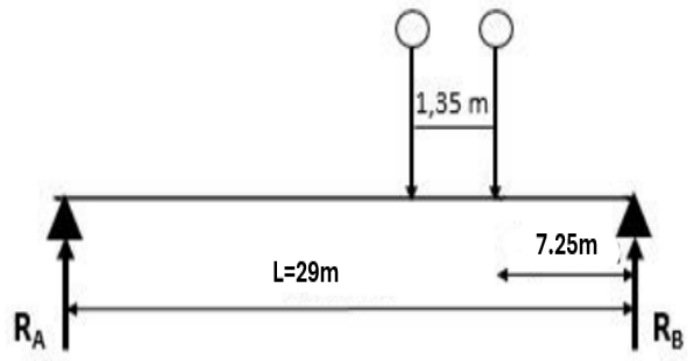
Poutre sous la surcharge Bt à (x=L/4)
